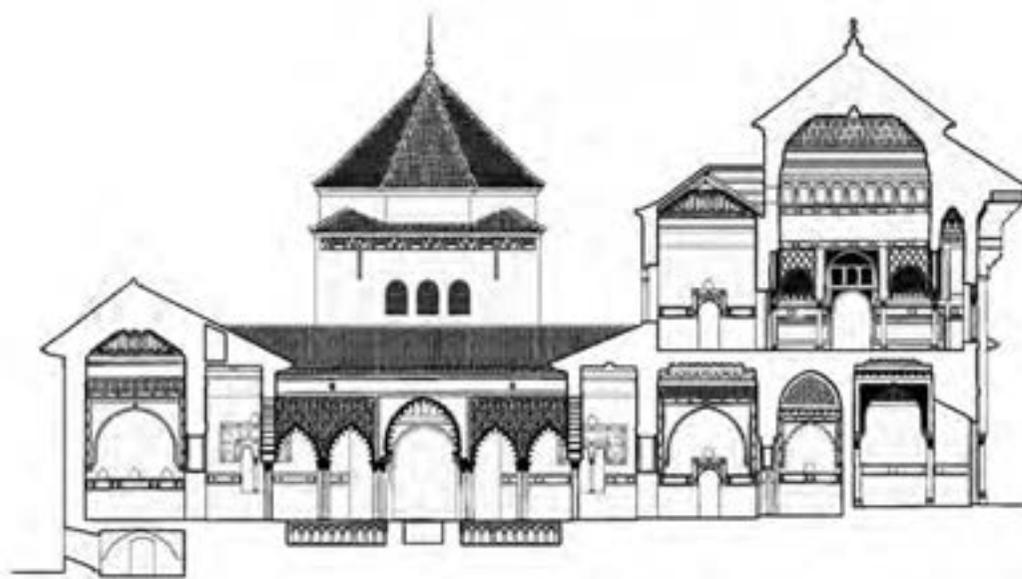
Sección general exterior del Palacio del Rey Don Pedro. Restitución. (Planimetría base: Almagro 2005: 65).
